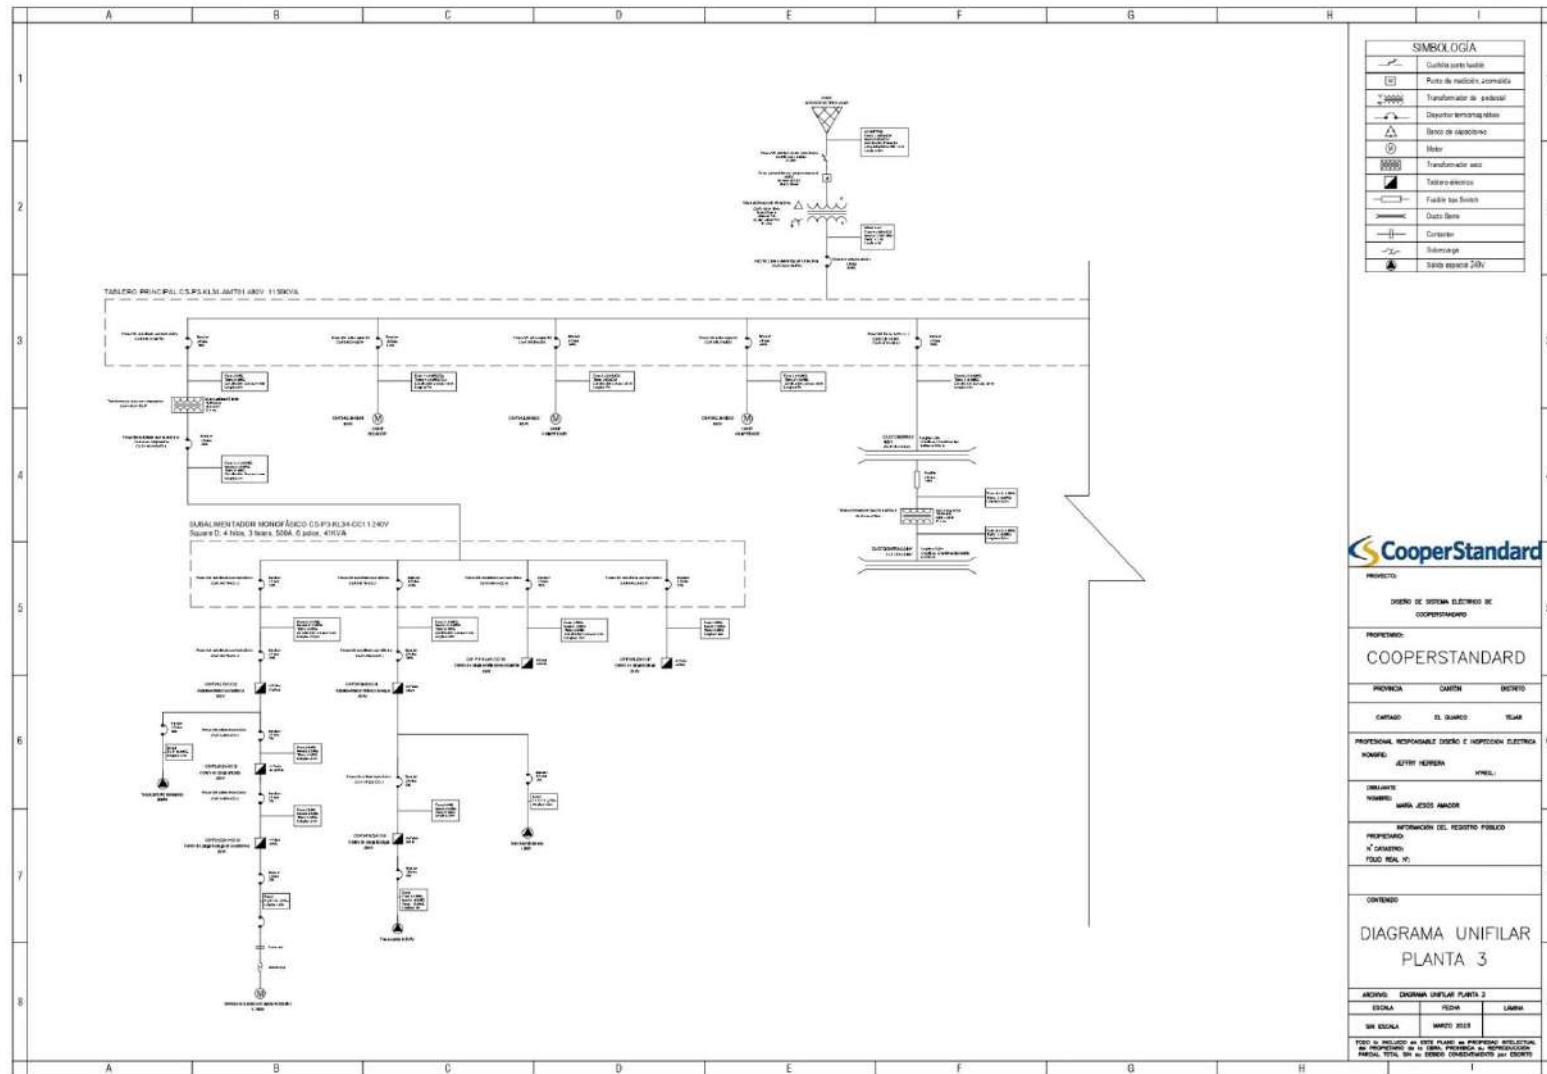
Diagrama unifilar, Planta 3. Parte 1 Fuente: Elaboración propia, realizado en AutoCAD (2023).
